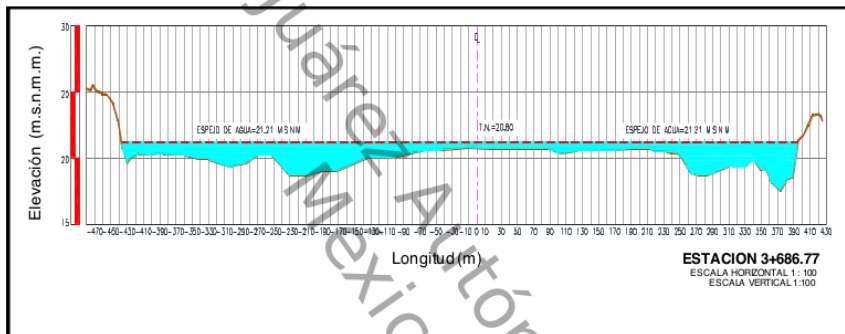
Sección Transversal Tipo. Cadenamiento 3+686.77
